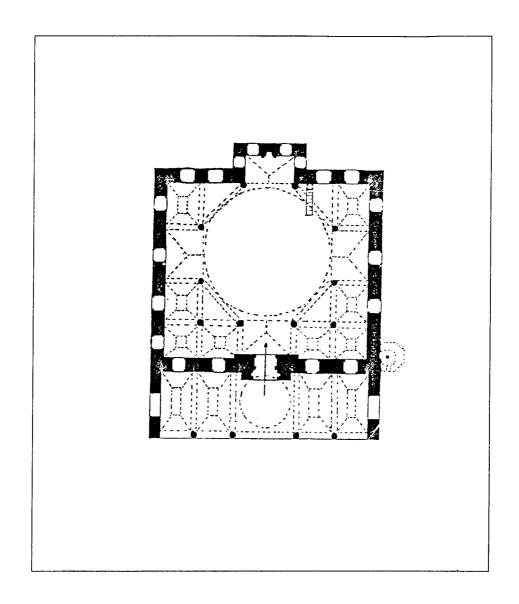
مسقط أفقي لمسجد عتيق علي باشا في ذنجرلي قويو باستانبول (عن : كوران) .
